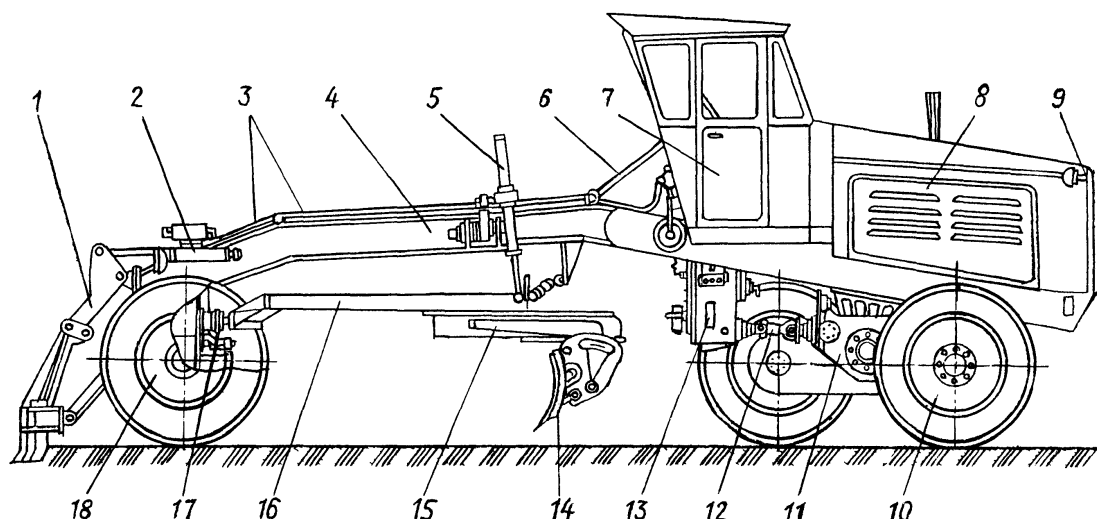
Конструктивная схема автогрейдера: 1 – рыхлитель; 2,5 – гидроцилиндры; 3,12 – карданные валы; 4 – основная рама; 6 – вал рулевого колеса; 7 – кабина; 8 – двигатель; 9 – радиатор; 10 – задний мост; 11 – сцепление; 13 – коробка перемены передач; 14 – отвал; 15 – поворотный круг; 16 – тяговая рама; 17 – цапфа переднего моста; 18 – передний мост
